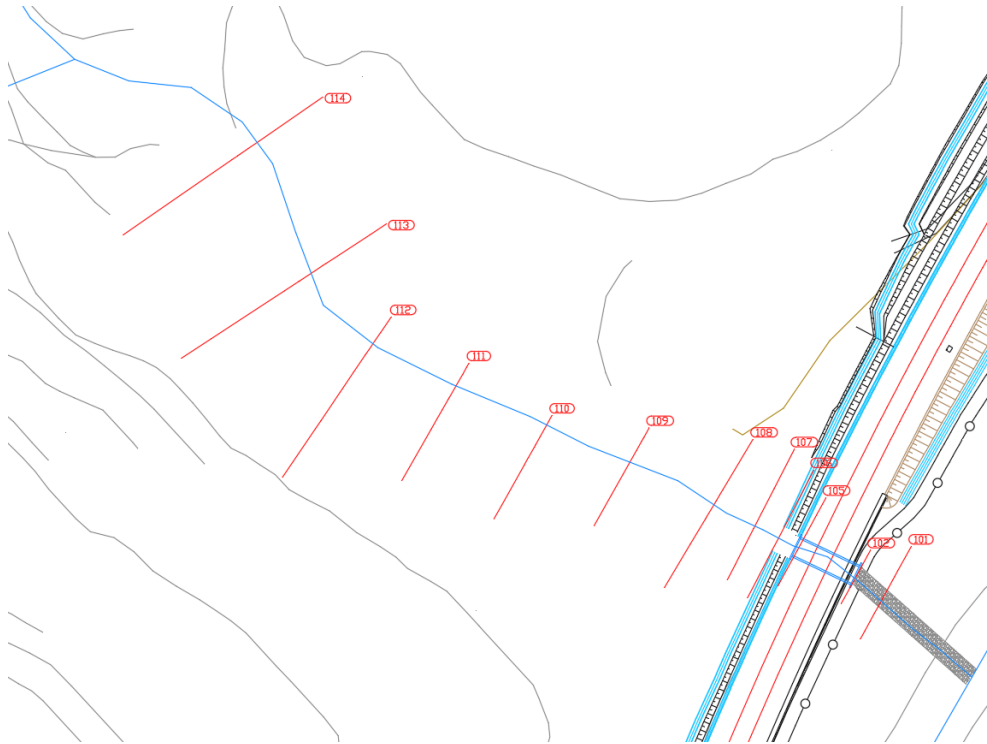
Schema planimetrico dell'asse IN02 in condizioni Post Operam
